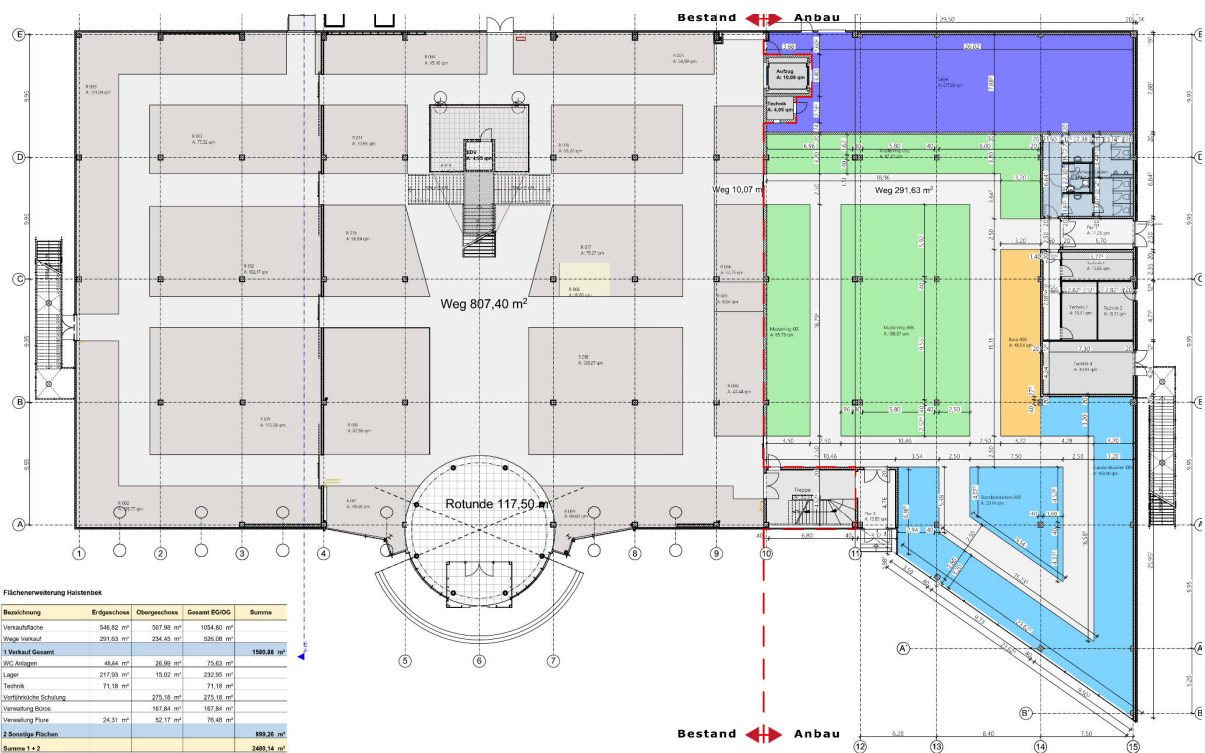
Grundriss EG mit Erweiterungsanbau in Farbe
